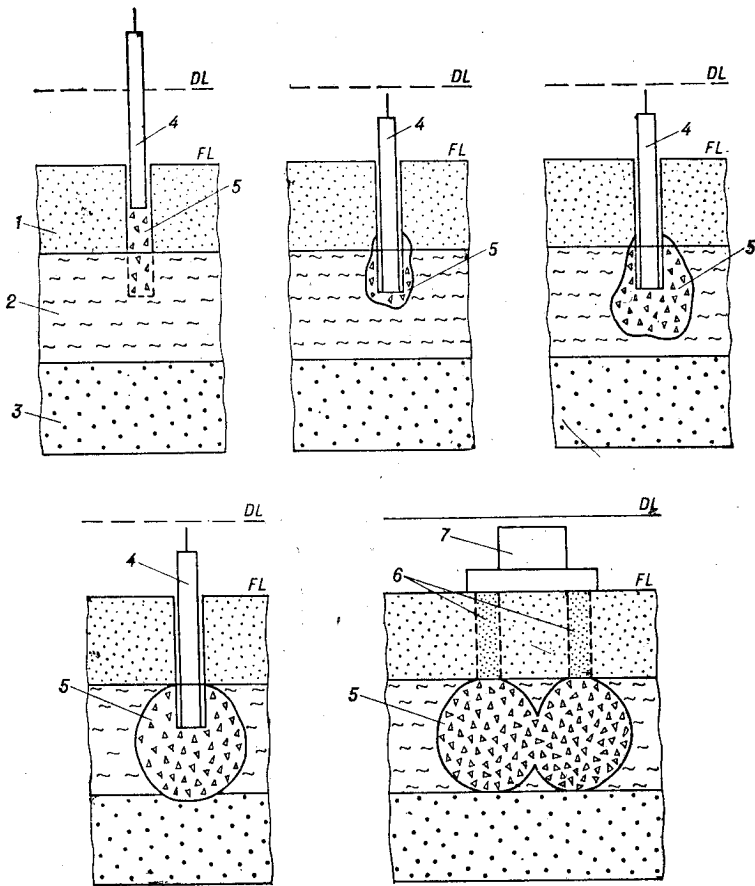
Послідовність влаштування фундаменту на слабкому підстильному шарі, який укріплено втрамбуванням щебеню (пробивка свердловини, стадії втрамбування щебеню, влаштування фундаменту мілкою закладення): 1 — нам'ятий ґрунт; 2 — слабкий шар; 3 — підстильний шар; 4 — циліндрична трамбувка; 5 — порції щебеню; 6 — свердловини; 7 — фундамент
